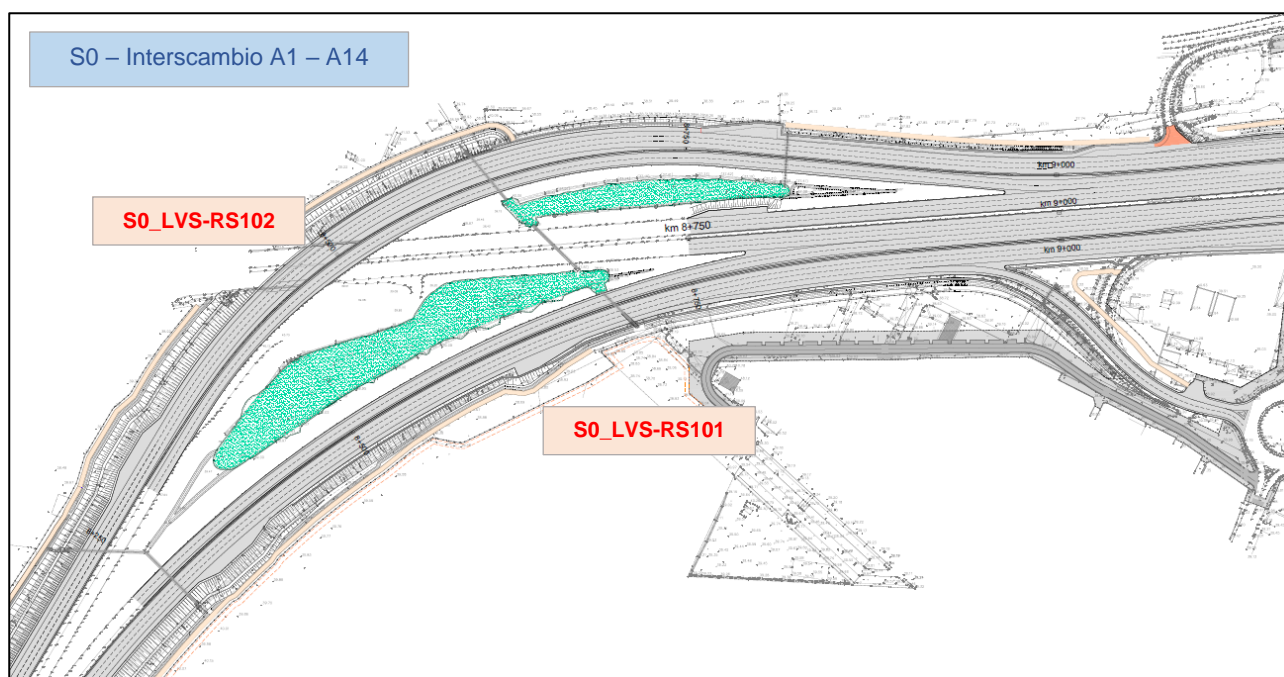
Stralcio planimetrico Interscambio A1-A14
